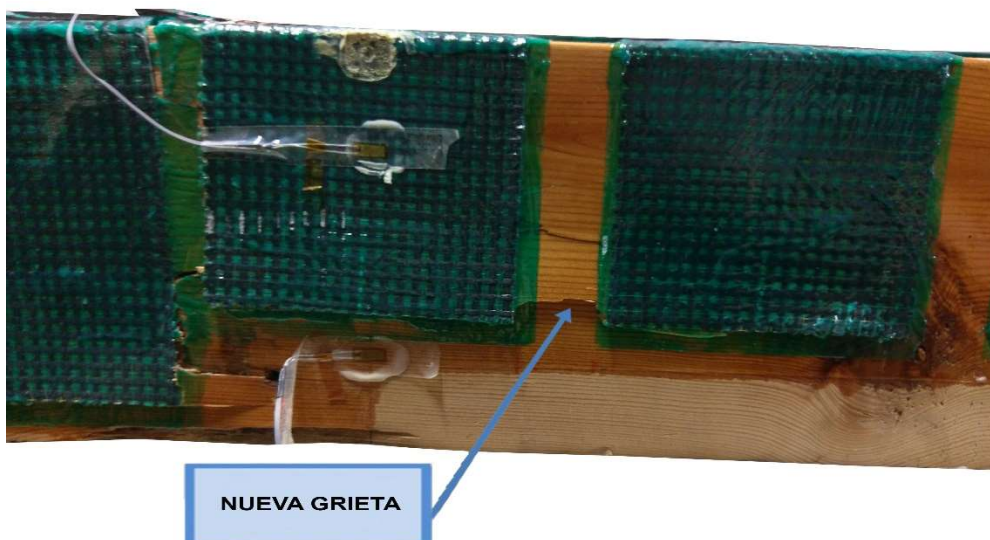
Reapertura de grieta existente en la rotura previa de la viga BR-r-1.
